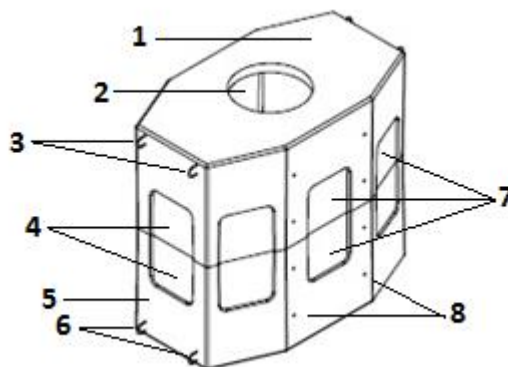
Внешний вид и детали колодца «ККСр-3,5-10(80)»:
